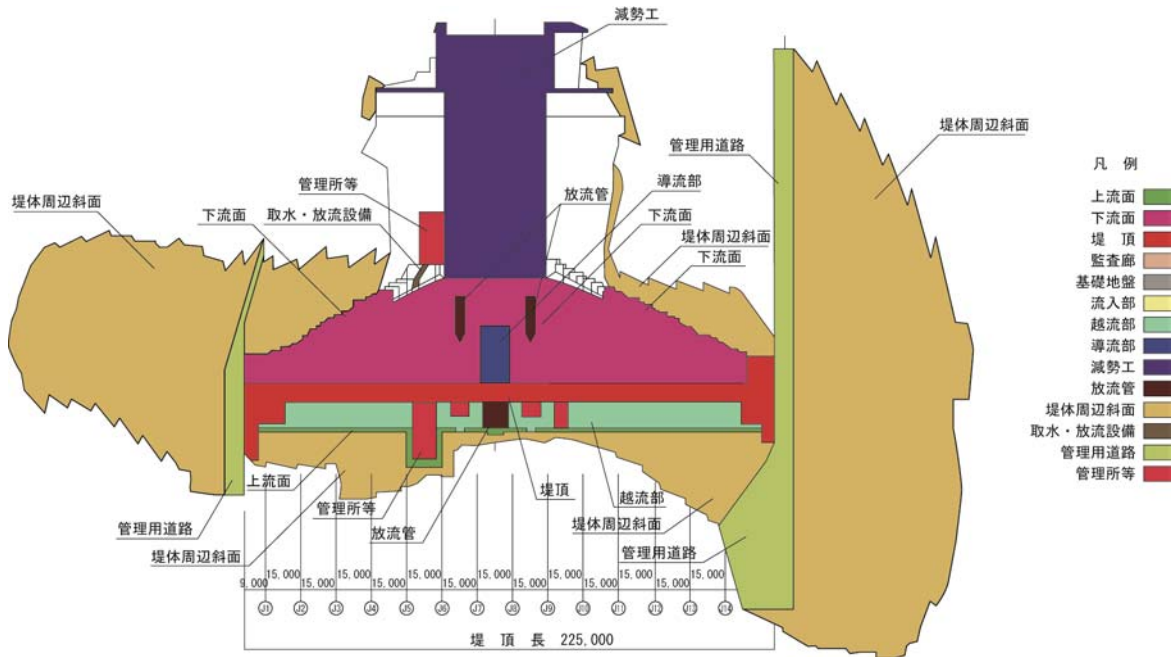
重力式コンクリートダムの構成要素（平面図）
